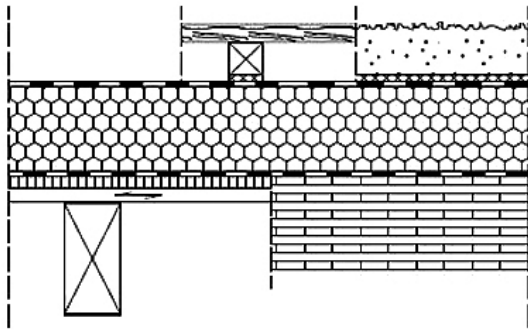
Estrutura de telhado plano ventilado com vigamento visível
